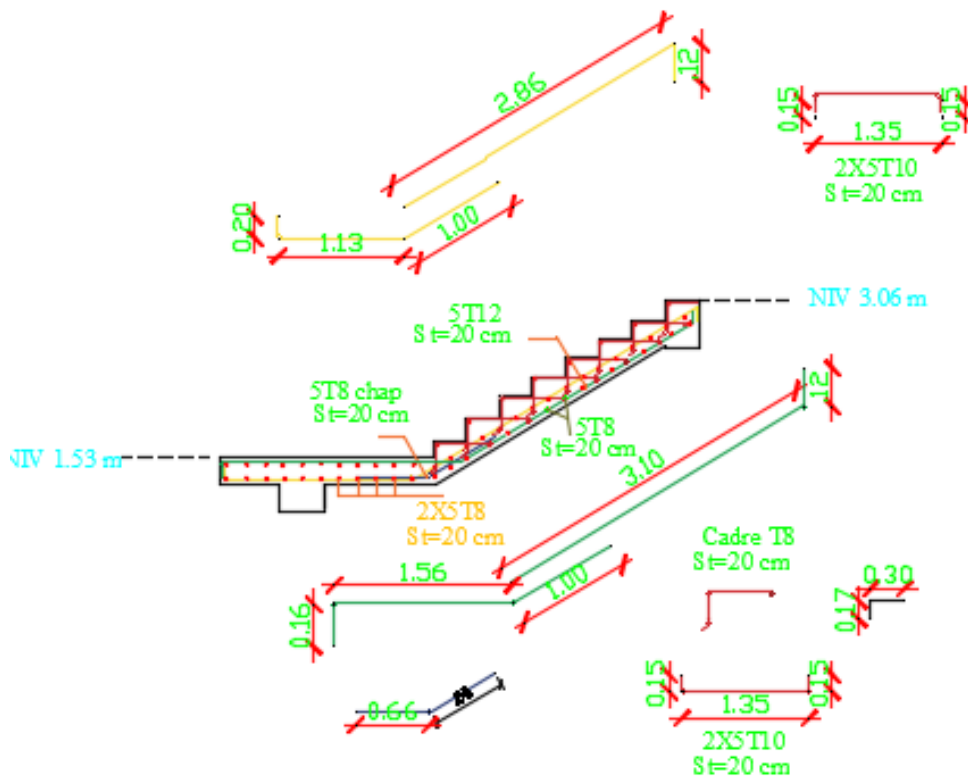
Schéma statique de ferrailage d'escalier à l'ELU
